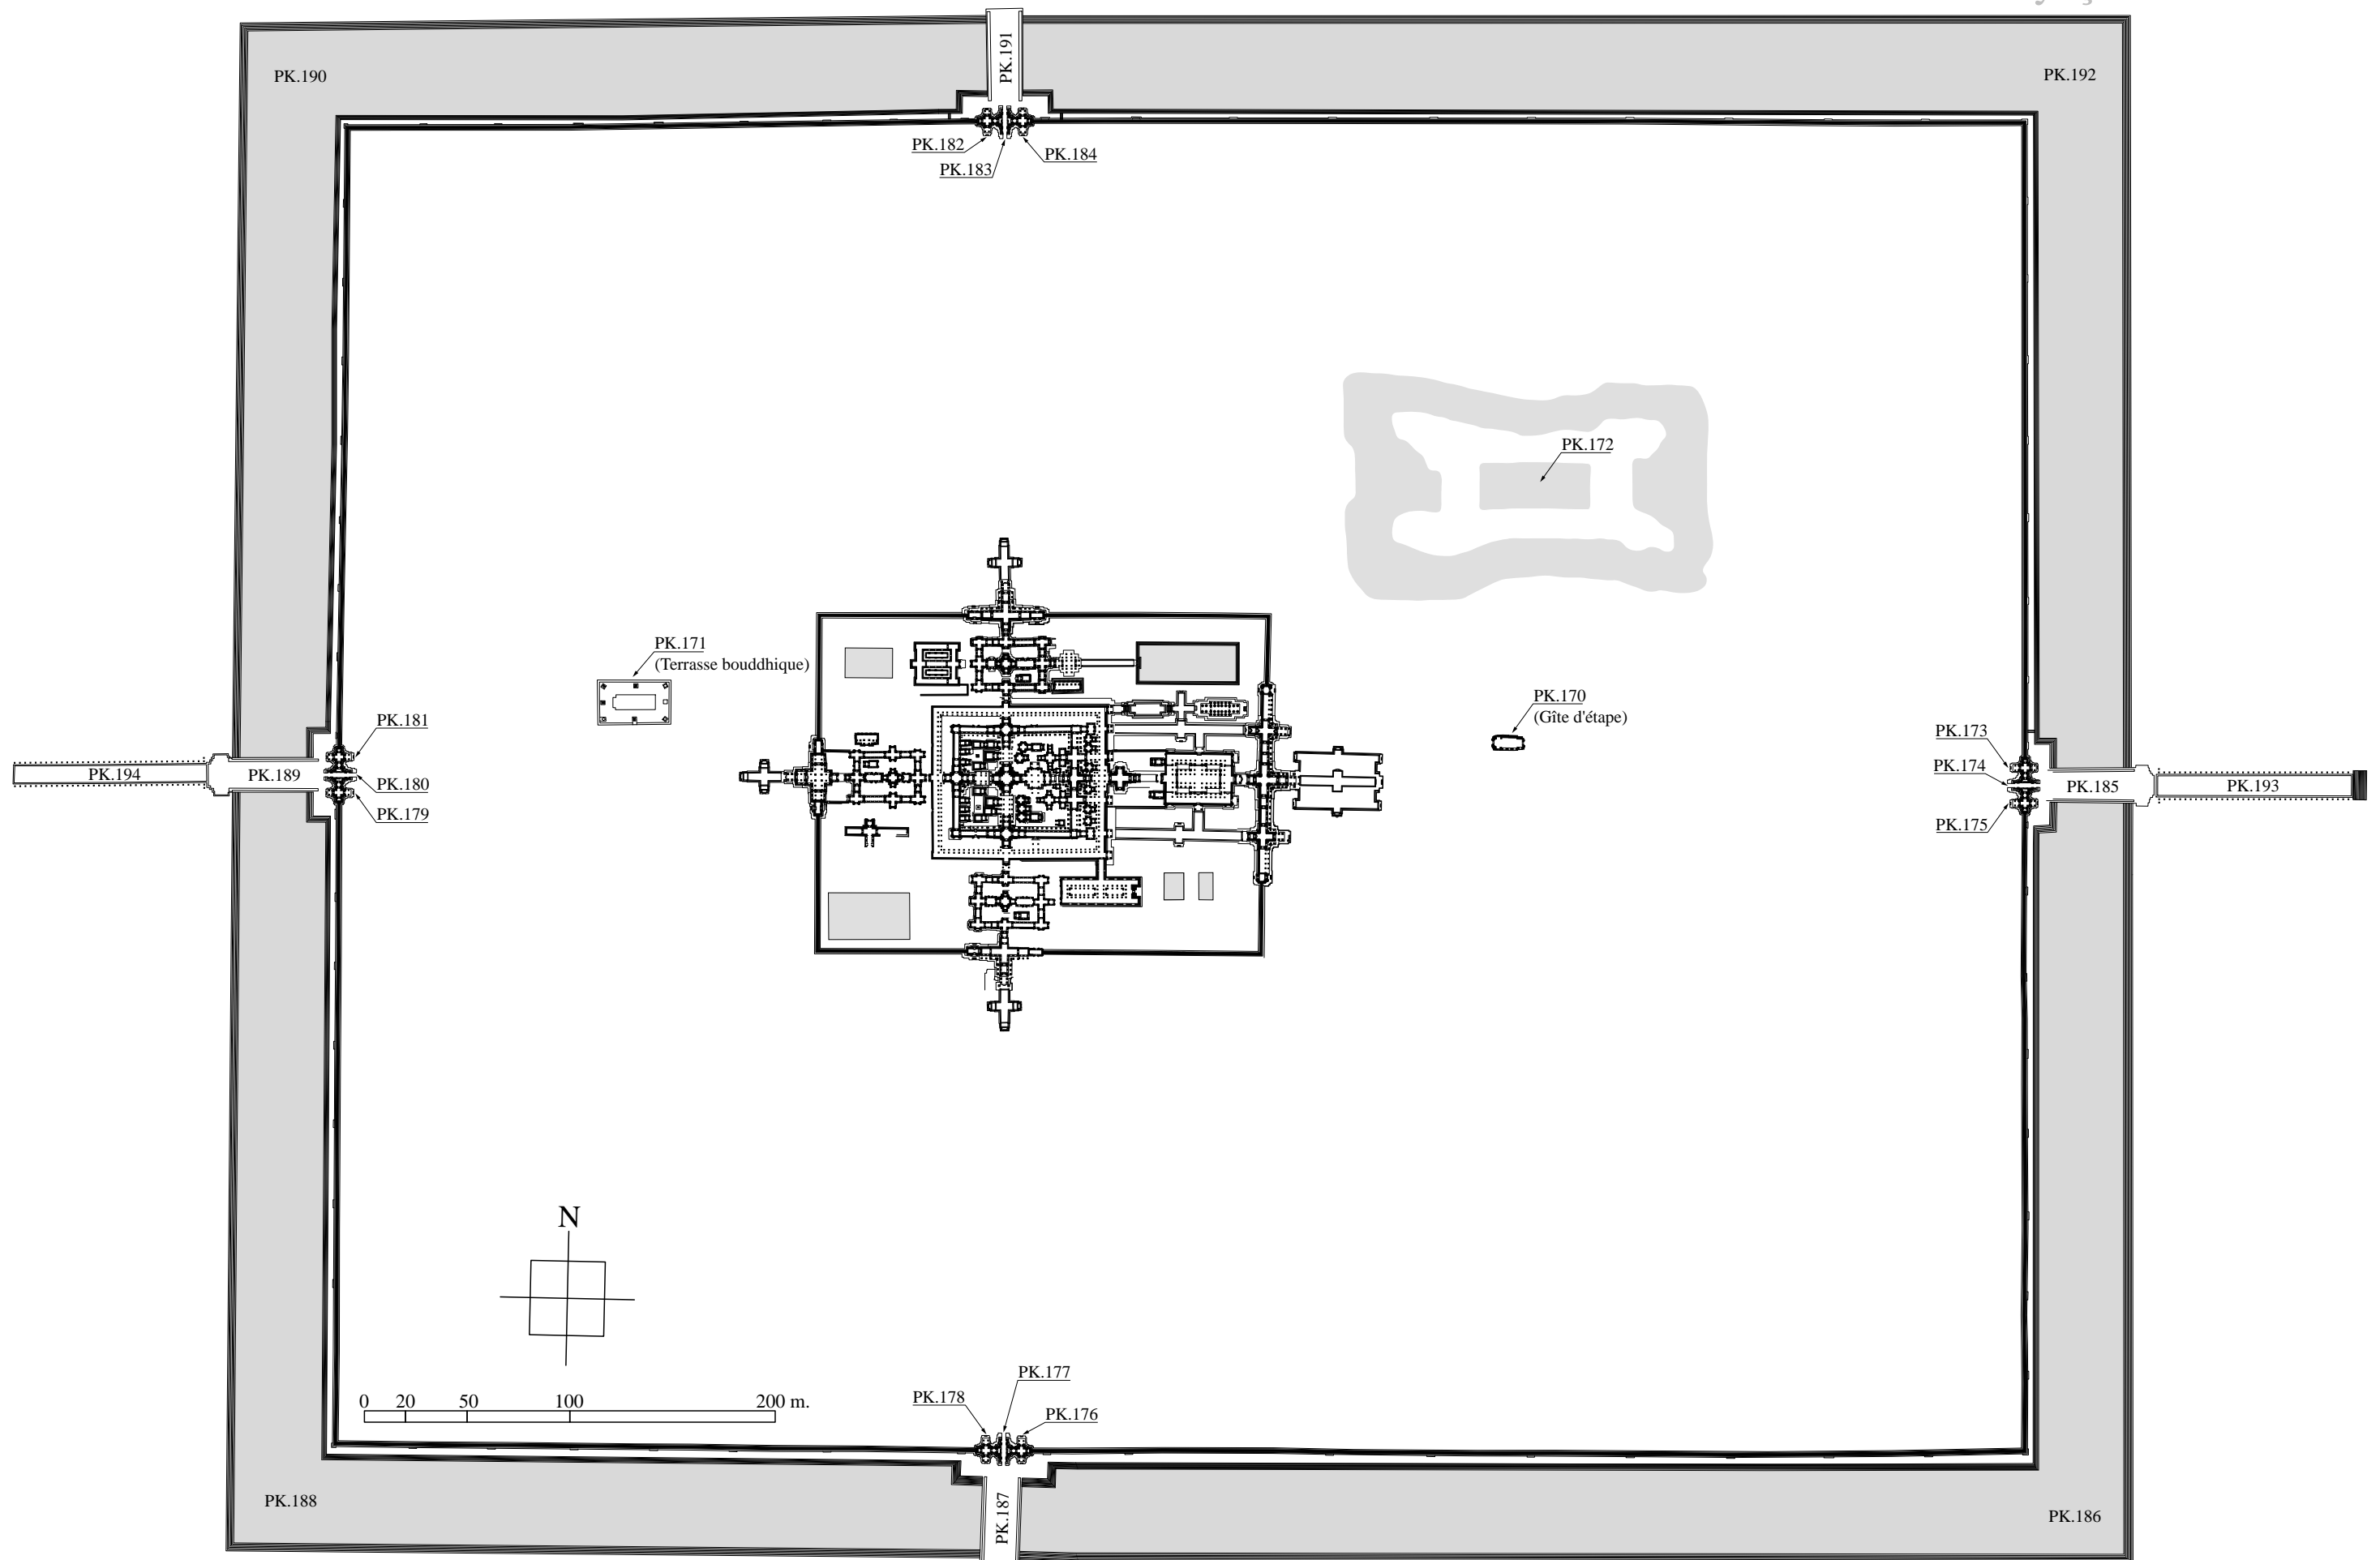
Plan du domaine de Jayaçrī (Preah Khan d'Angkor)
